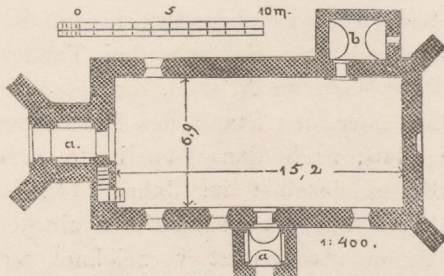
Kgl. Dombrowken. Grundriss der Kirche.
